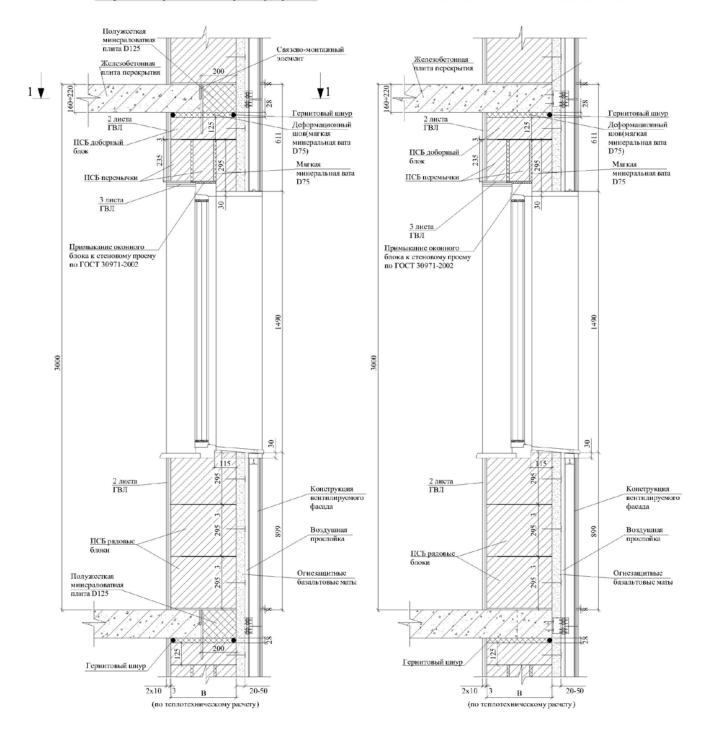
Ненесущая стена из ПСБ блоков с вентилируемым фасадом. Вертикальные разрезы по оконному проему (термовкладышу и шпонке в перекрытии)
